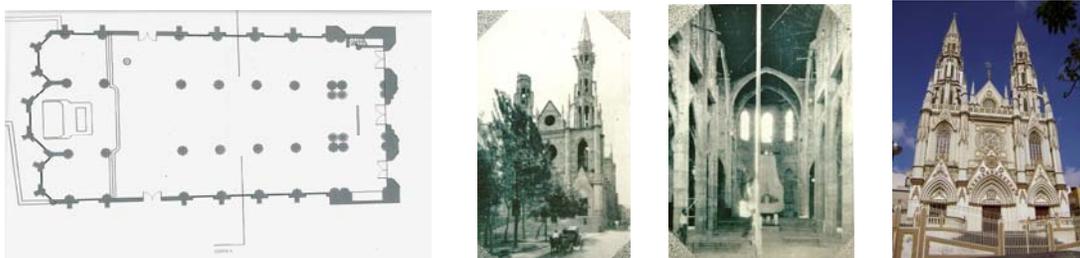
Iglesia Inmaculada Concepción 1927. a.- Planta, b.- Exterior en construcción, c.- Interior en construcción, d.- Exterior actual.
